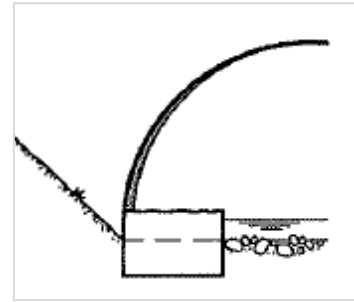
Bachdurchlass mit Berme (route et traffic N 6/2011)
